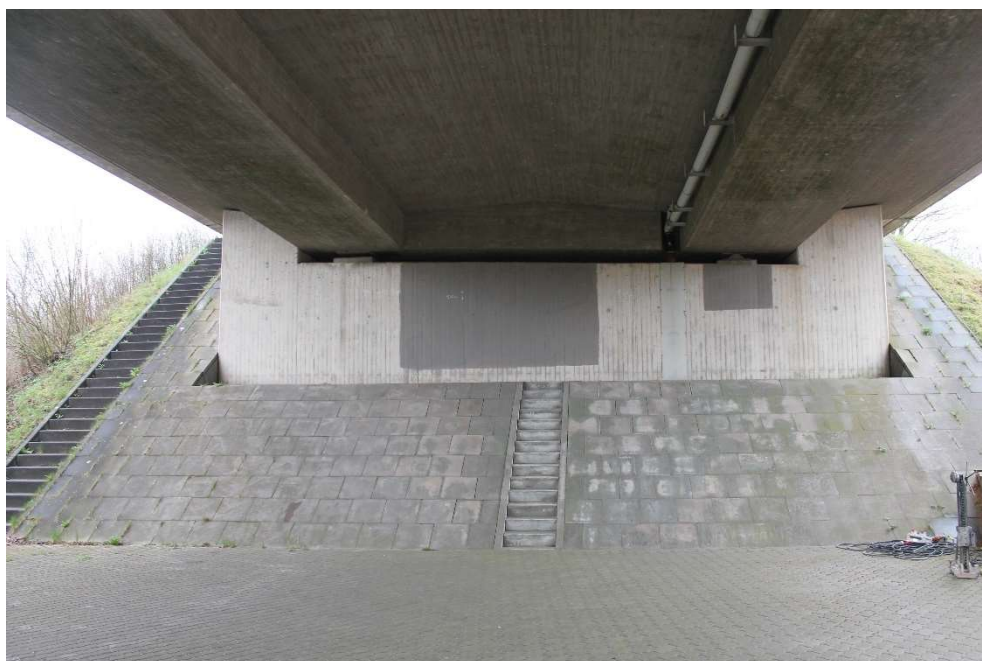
Další případy drolení betonu způsobené korozí betonářské výztuže v severovýchodní části.
